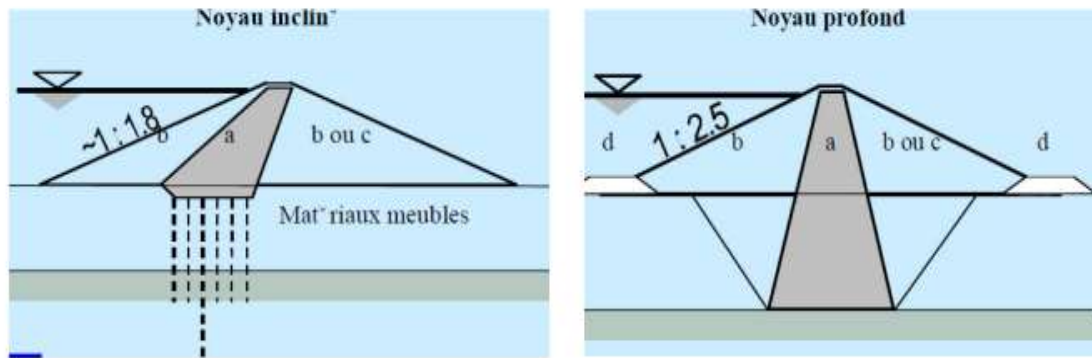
Types de fondation de barrage en remblai sur matériaux meubles :
